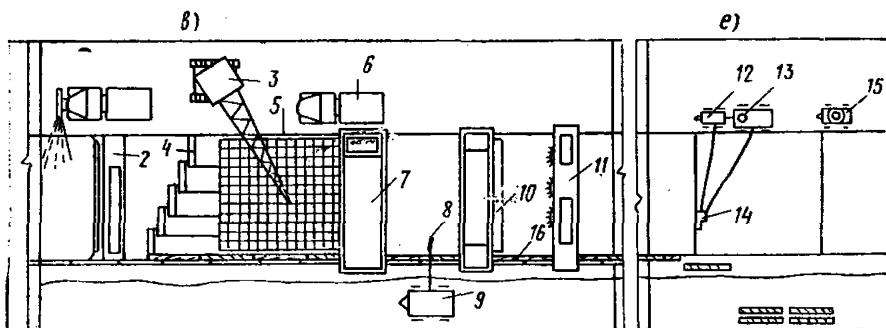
Технологическая схема устройства железобетонного покрытия по захваткам
